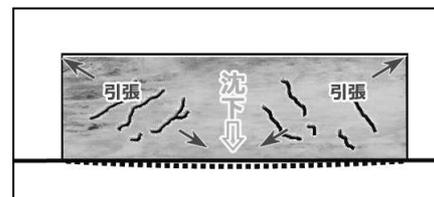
擁壁乾燥収縮ひび割れ図
